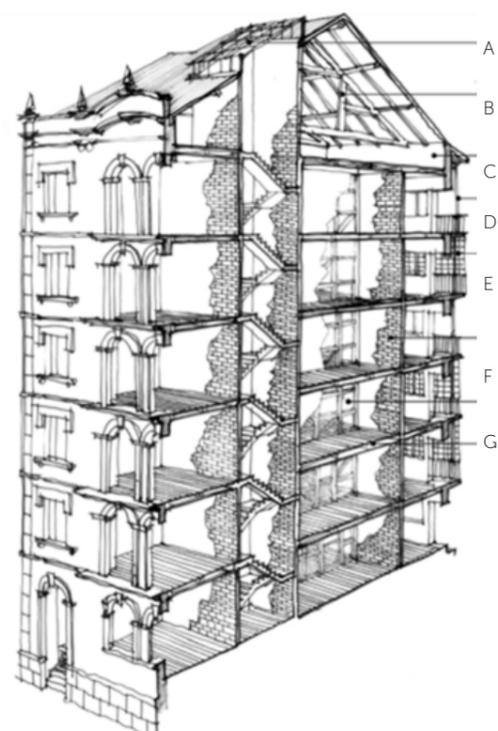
Schema di un edificio *gaioleiro*. A – lucernario per il vano scala; B – orditura di travi di copertura semplificata; C – pareti portanti in pietra; D,E – strutture metalliche sul retro; F – pareti parallele alla facciata in mattoni; G – pareti perpendicolari in *frontal* semplificato in legno; H – solai in legno.
